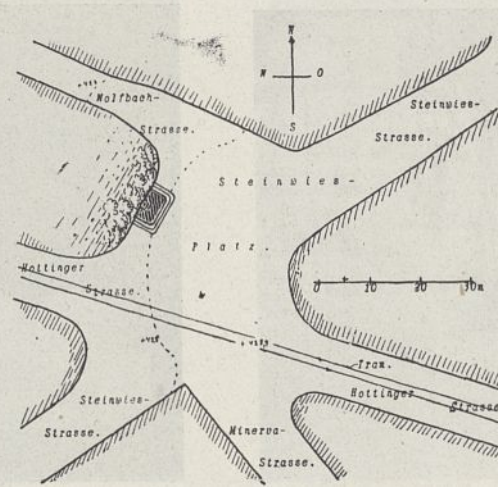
Zürich, Brunnen am Steinwiesplatz. Lageplan.
